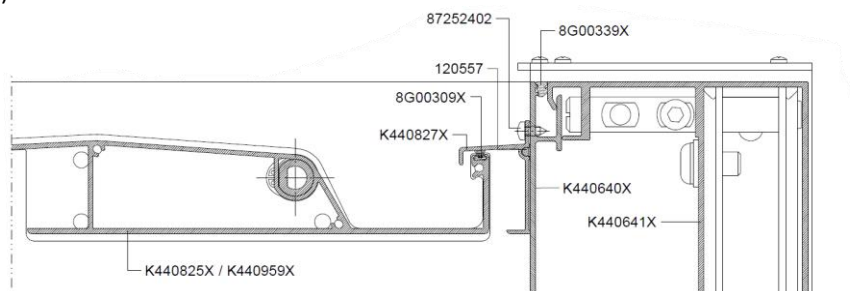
Montaż dolnego zakończenia dachu typu 2
